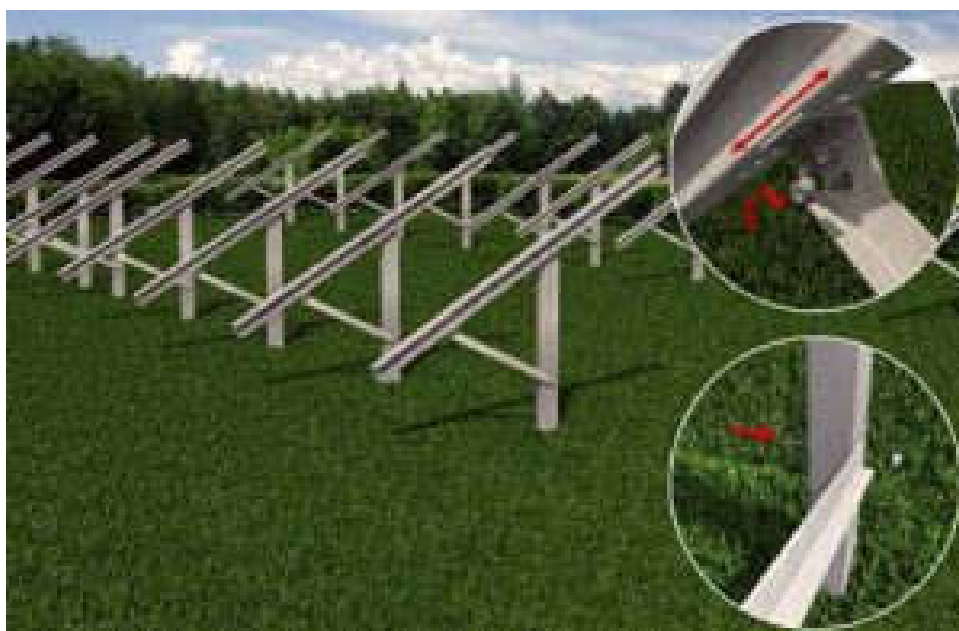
installazione strutture di sostegno – particolare di montaggio bulloneria
